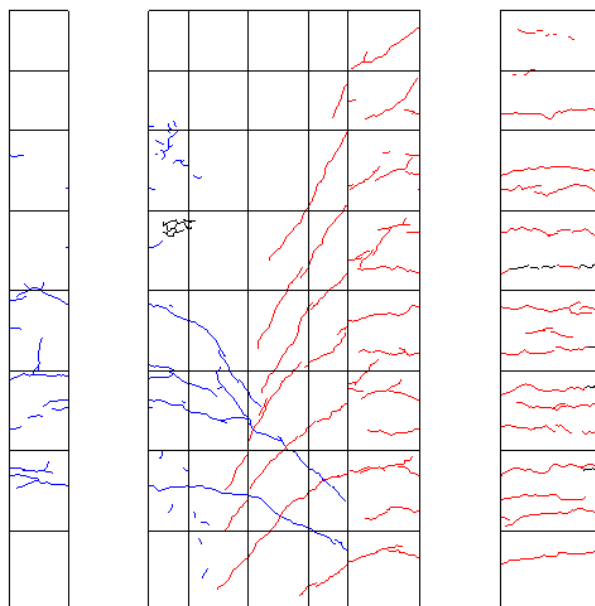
R=1/133 ひび割れ図
